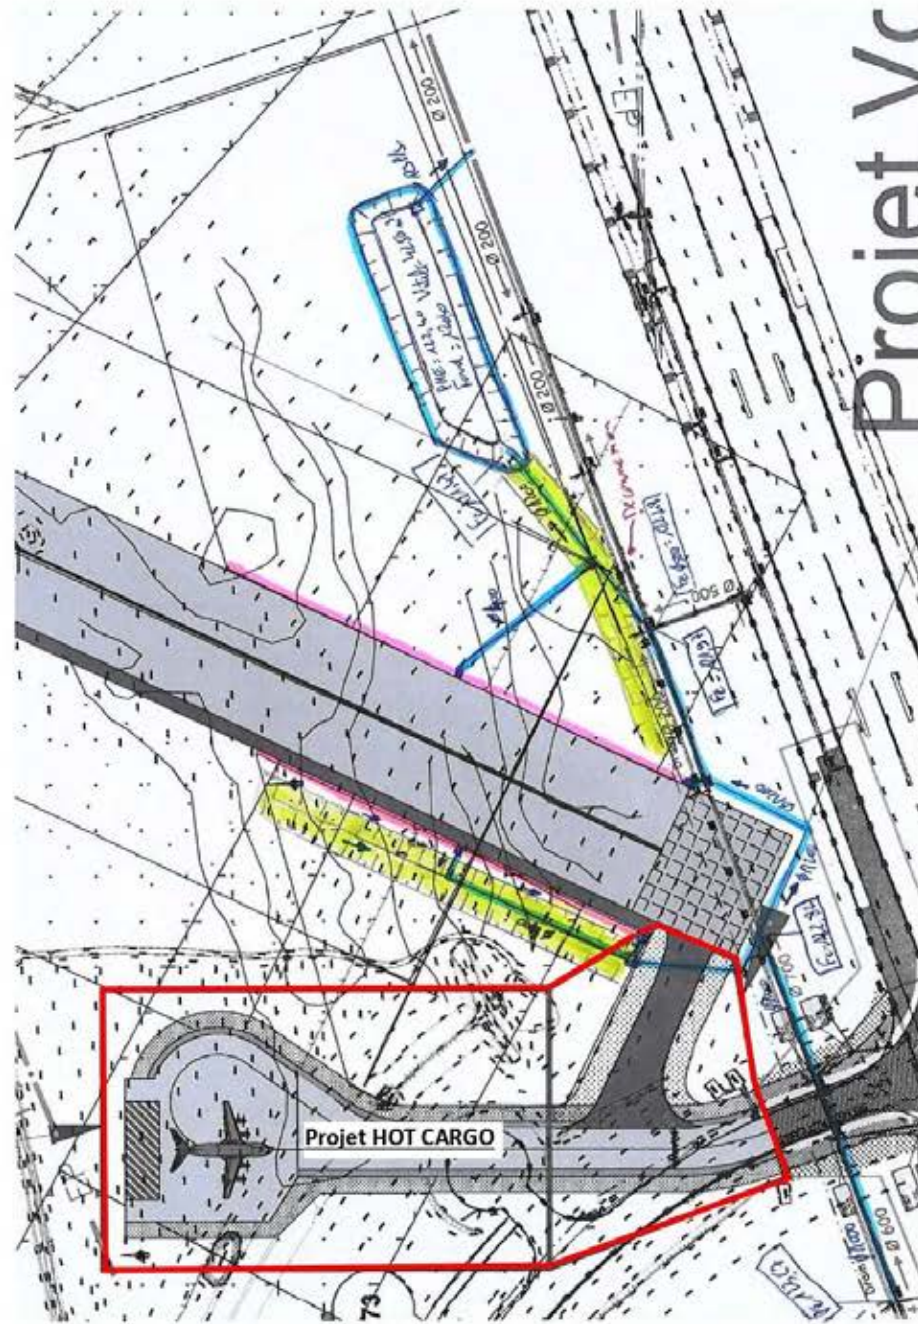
Impluvium Sud – solution 1 – plan d'aménagement
